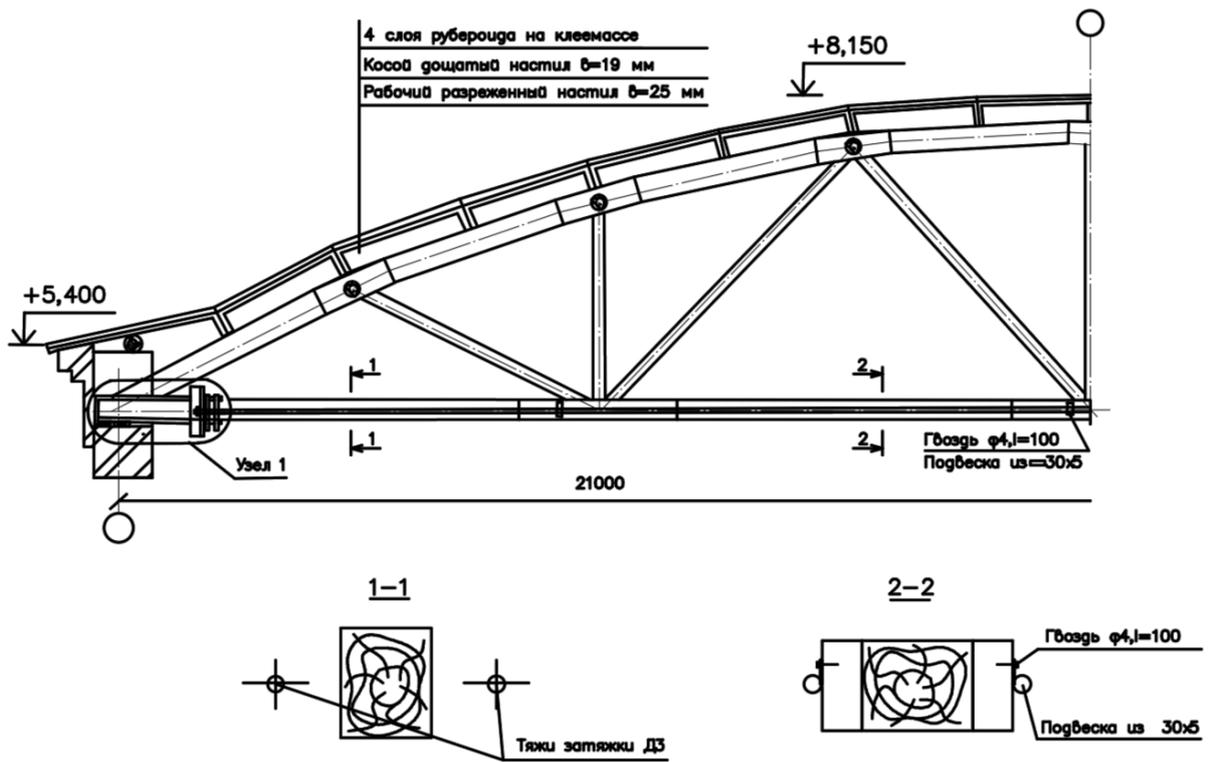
Усиление нижнего пояса фермы с помощью опорных затяжек, расположенных вдоль нижнего пояса
